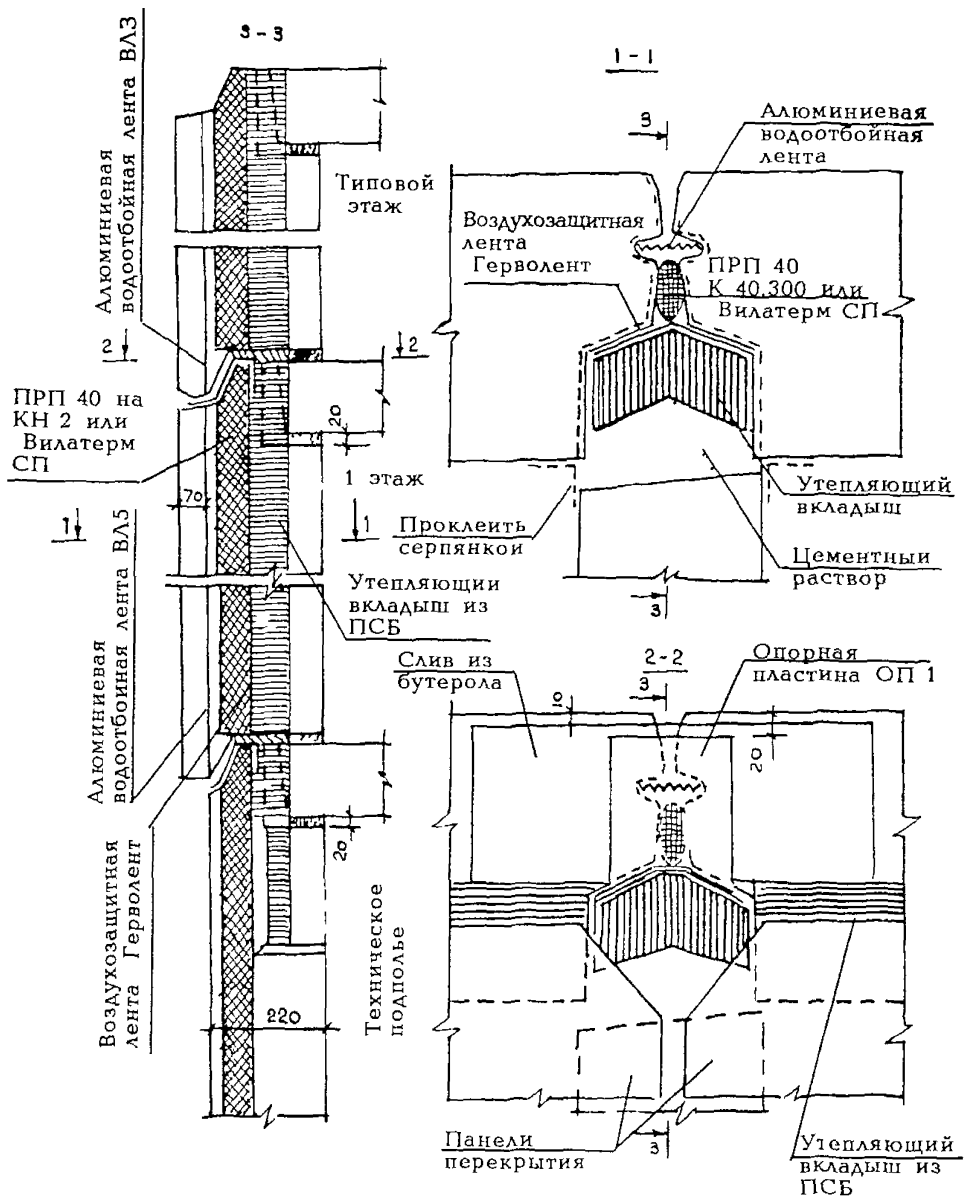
Замоноличенный вертикальный стык между панелями наружных и внутренних стен
